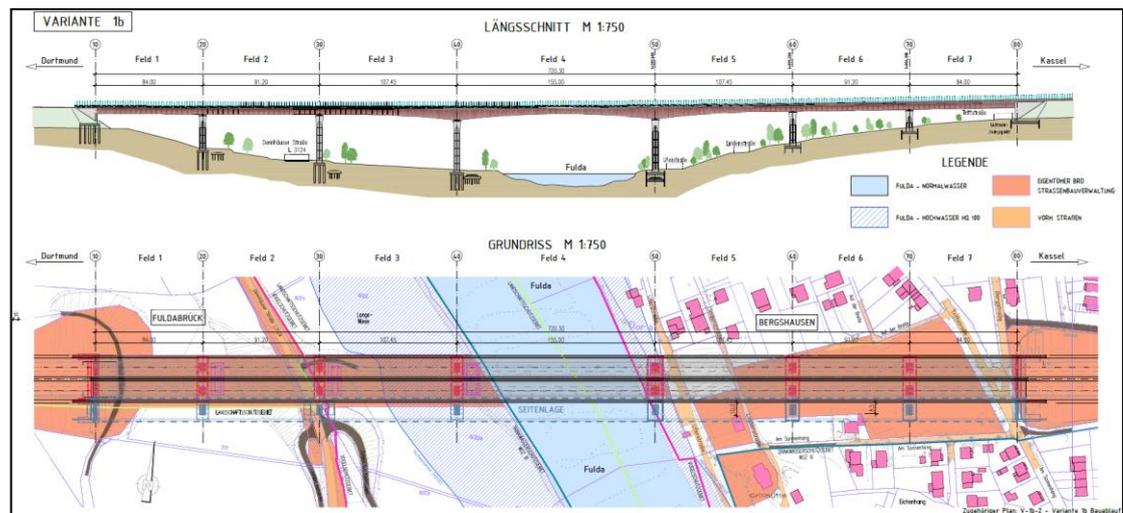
Längsschnitt und Grundriss Variante 1
